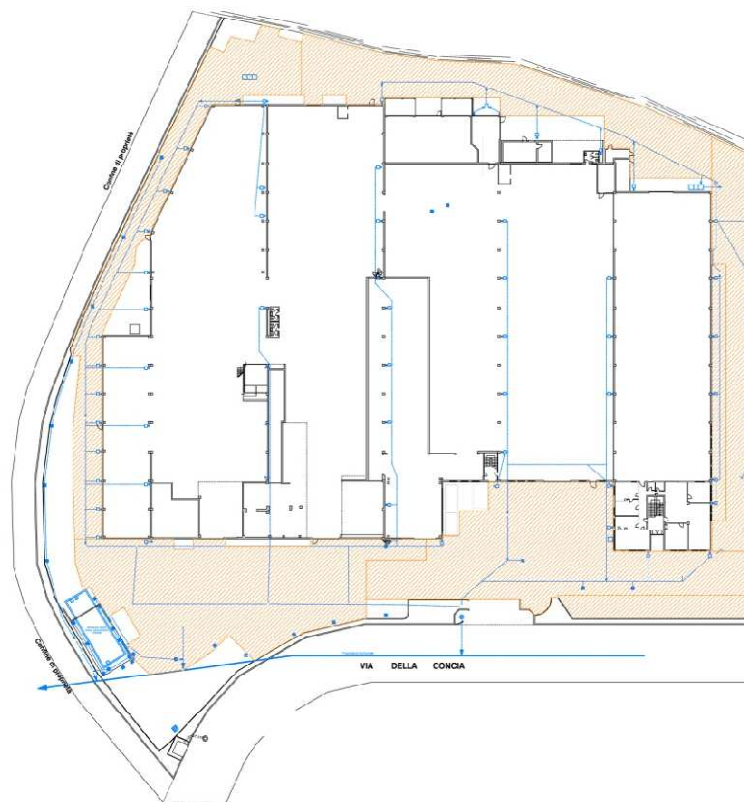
Stralcio planimetrico con le modifiche alla rete di caditoie.
